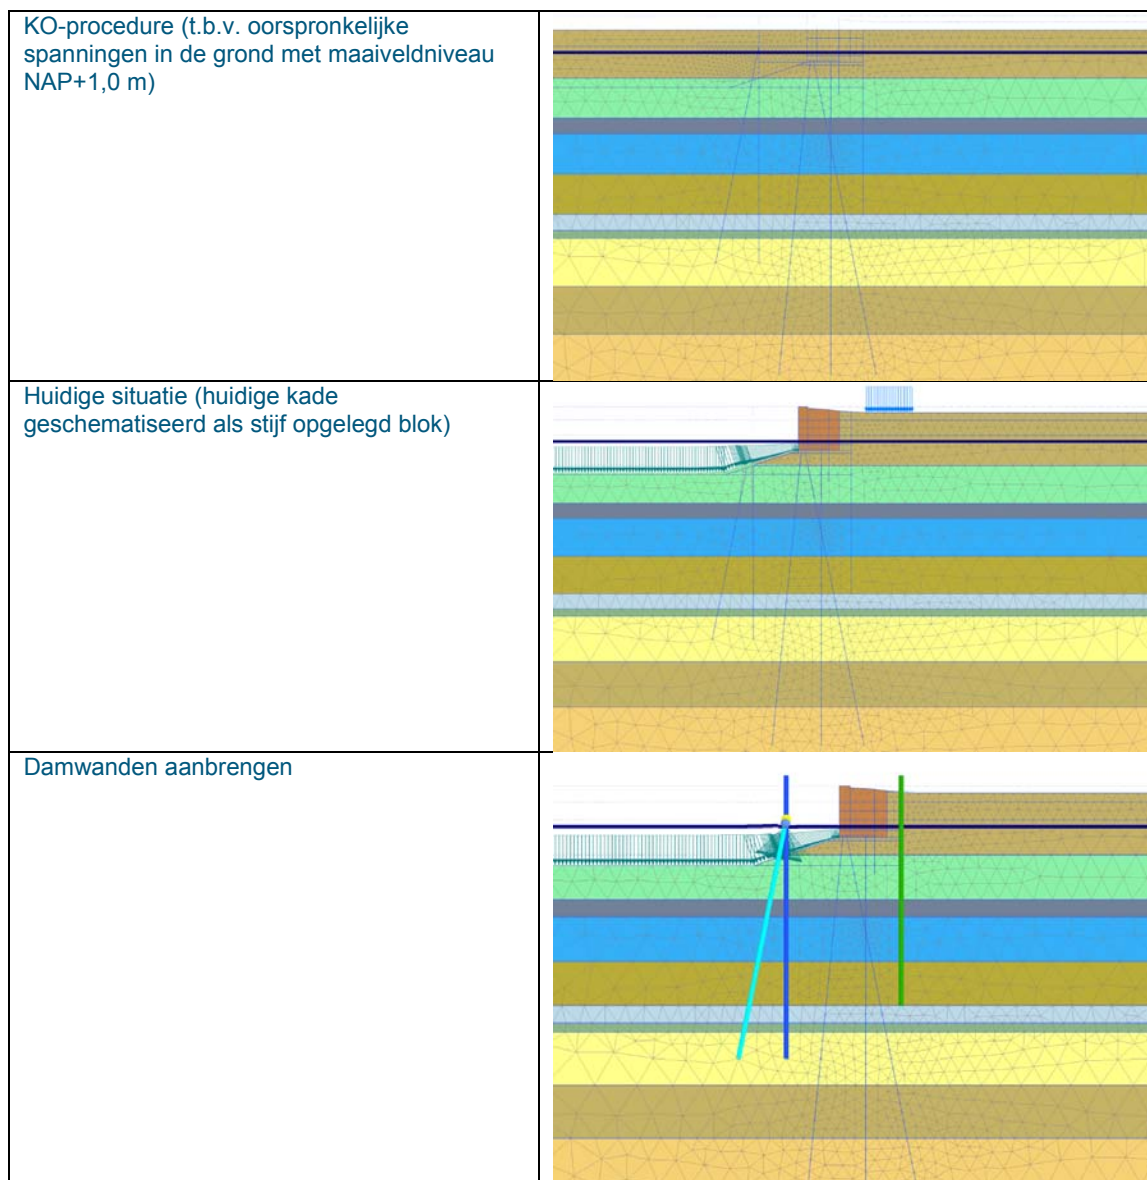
Invoer geometrie in Plaxis voor de hoge doorsnede
